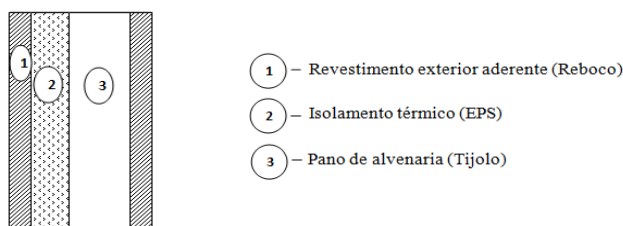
Parede simples de fachada com isolamento térmico pelo exterior
